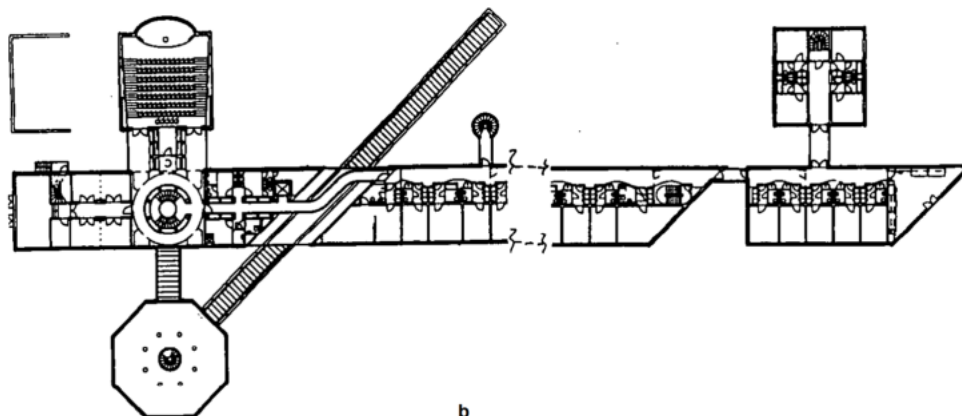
Planta do Pavimento Tipo. The Maersk Mckinney Moller Centre, Reino Unido
